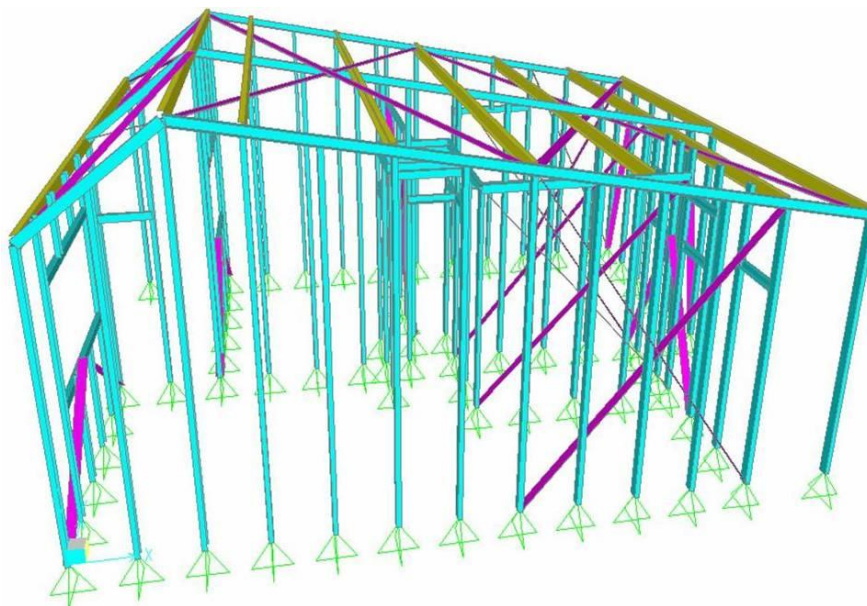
Esquema estrutural - (Fonte: RODRIGUES, 2008).
